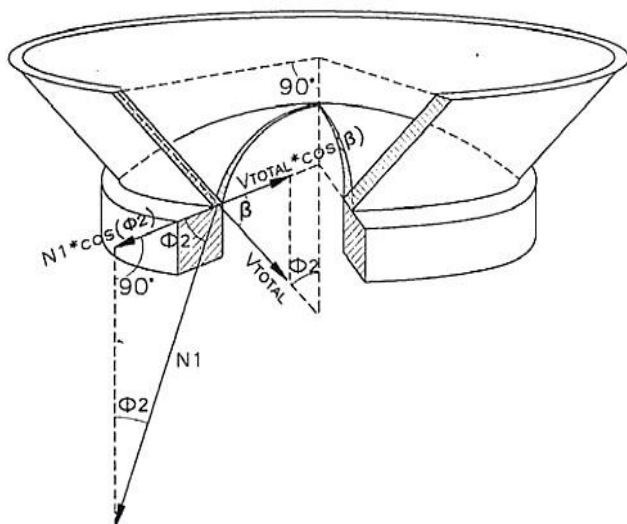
Esfuerzos sobre la viga de fondo. (Fuente: Quezada & Palacios, 2014).
